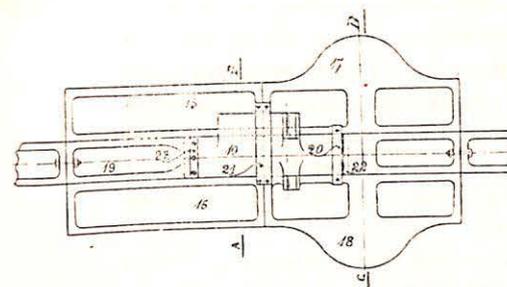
Pièces consolidant sur son pourtour le masque obstruant la plaie.
